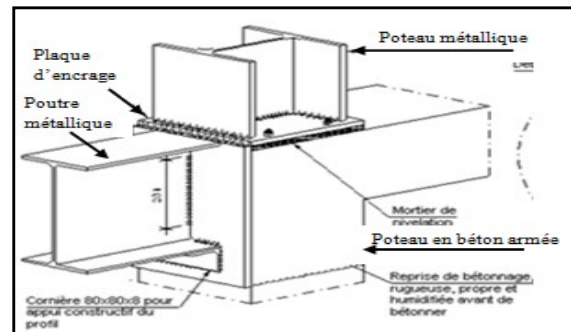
L'assemblage entre une poutre métallique et un poteau inférieur en béton et un poteau supérieur métallique / Source : les auteurs
